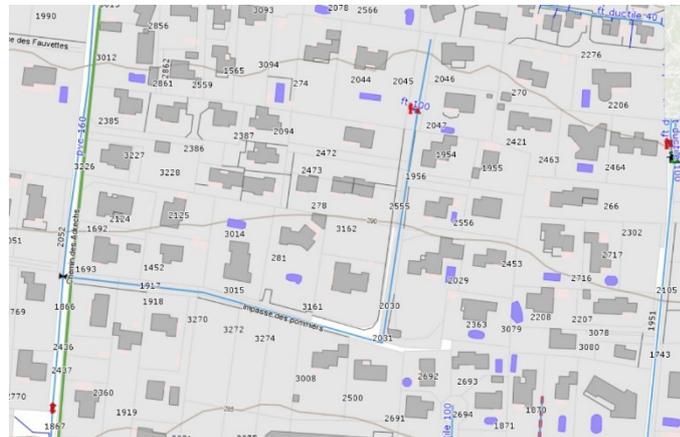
Plan du réseau d'alimentation en eau potable (source : Intragéo DLVA)
